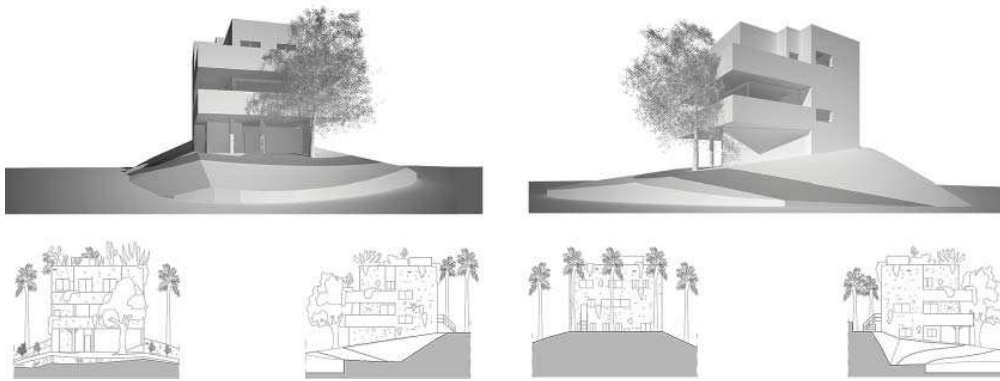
Casa do Chame-Chame, viste prospettiche e prospetti della prima versione (elaborazione grafica di M. G. Carollo).
